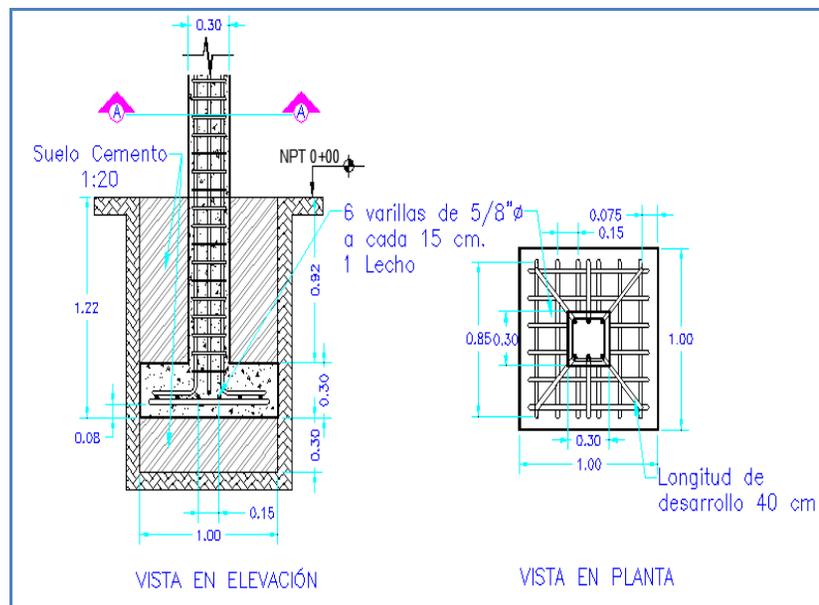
Esquema sin escala, de columna (C-1) y zapata(Z-1).
